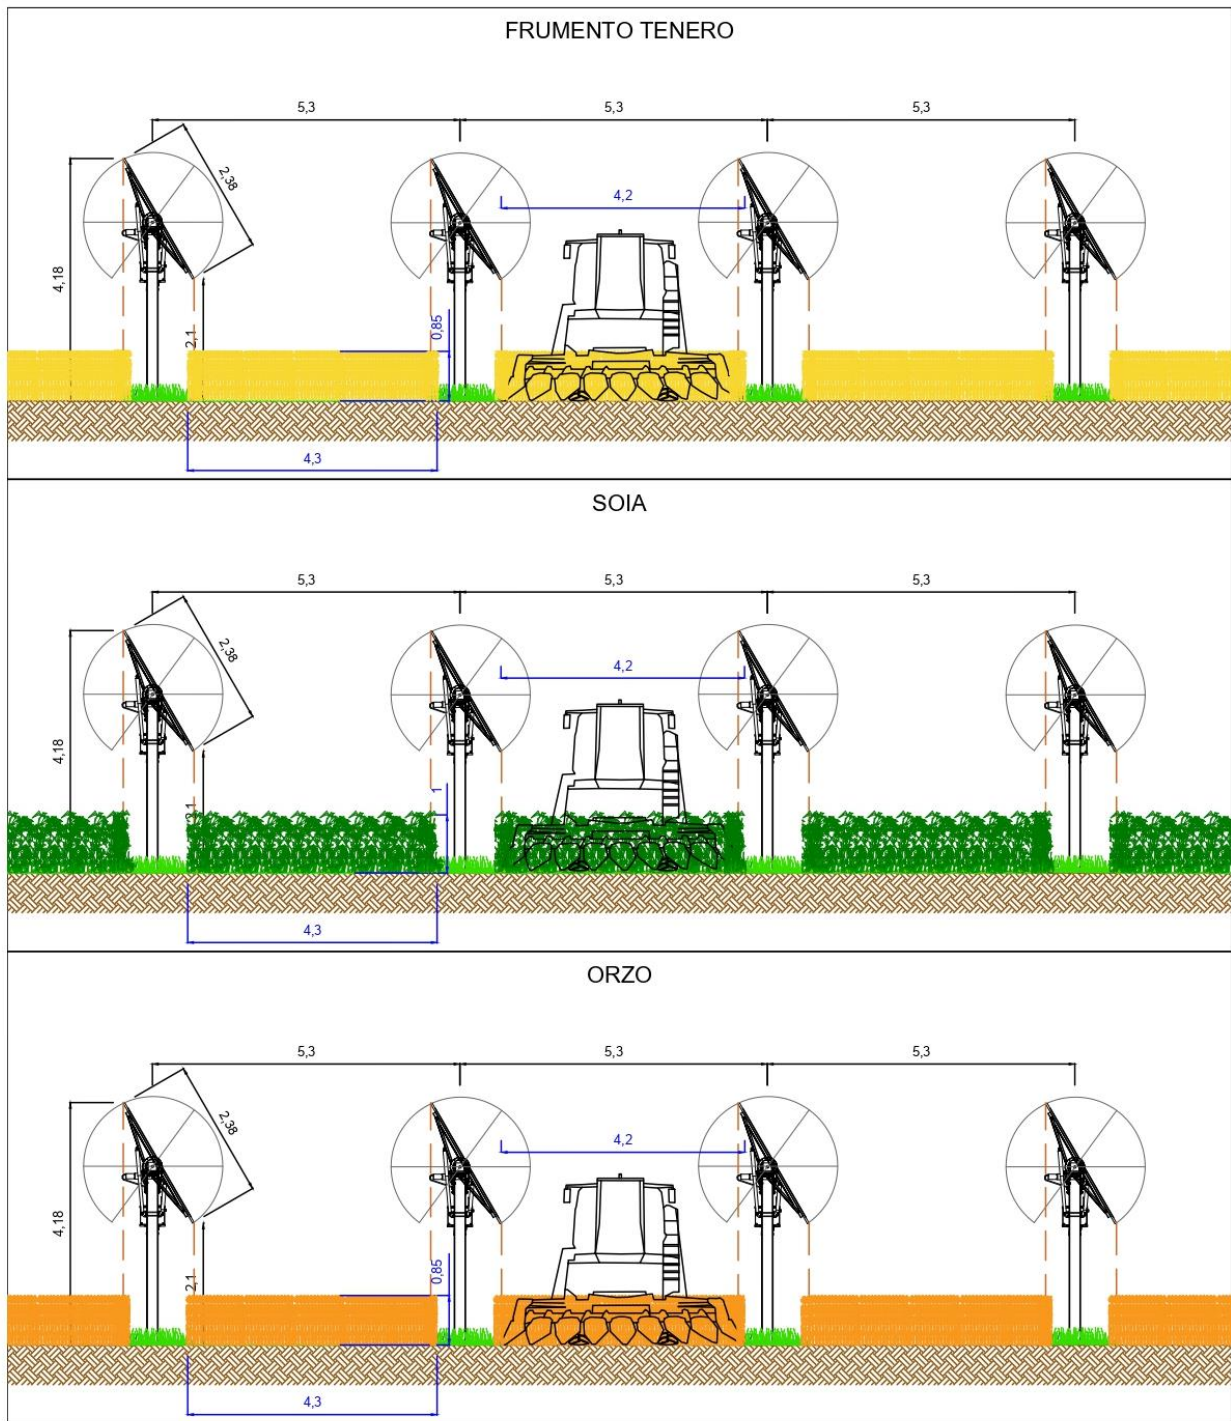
Rappresentazione del prospetto frontale delle colture di frumento tenero, soia e orzo
